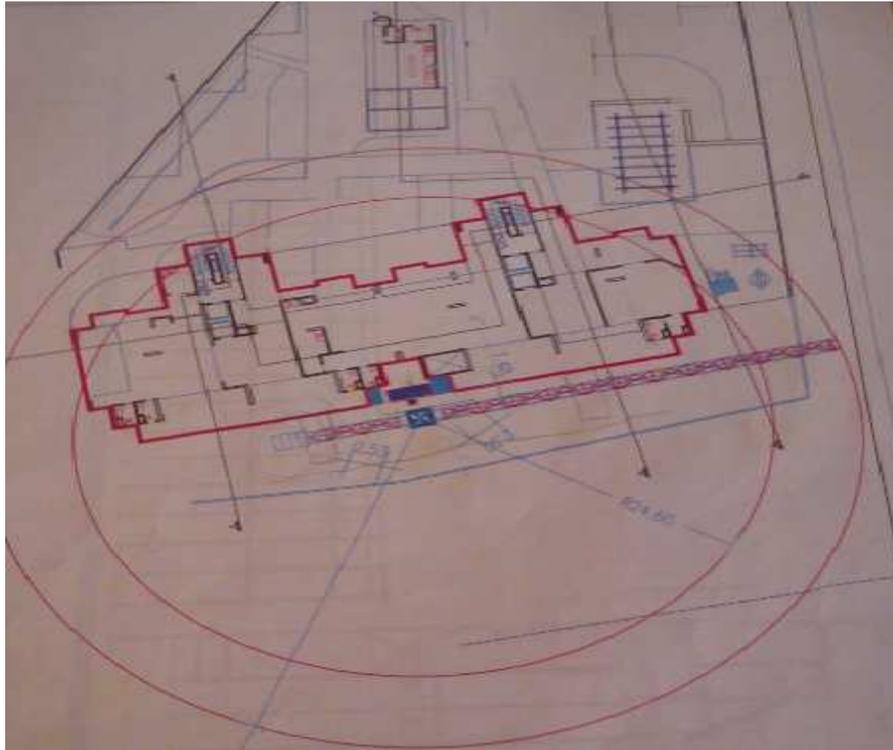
Plano de Posição e raio de giro do Equipamento no Canteiro
